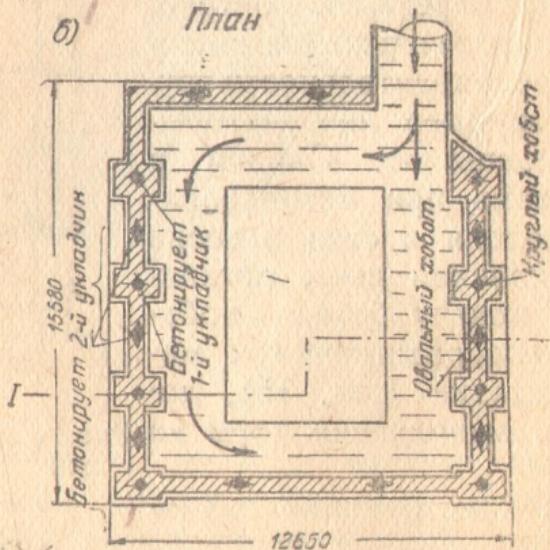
Схема организации бетонирования фундамента марленовской печи. В плане стрелками показано движение стерлингов.
